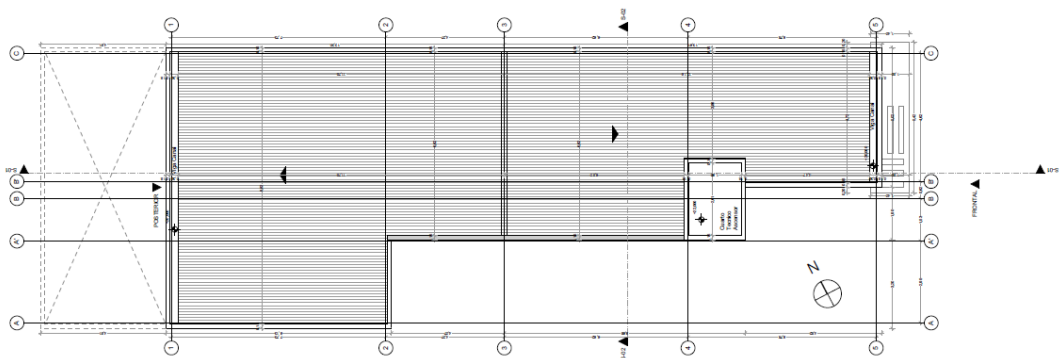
Planta Arquitectónica de Cubierta Actual Cafaba.
